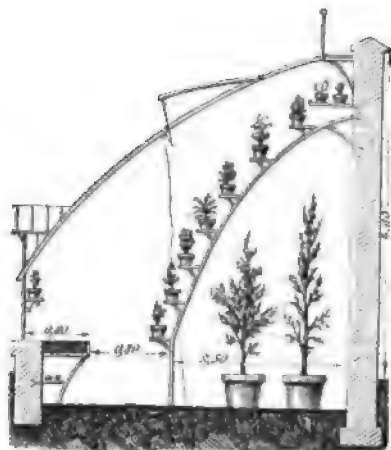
Coupe transversale d'une Serre hollandaise à multiplication (les principales dimensions sont indiquées en mètres).
